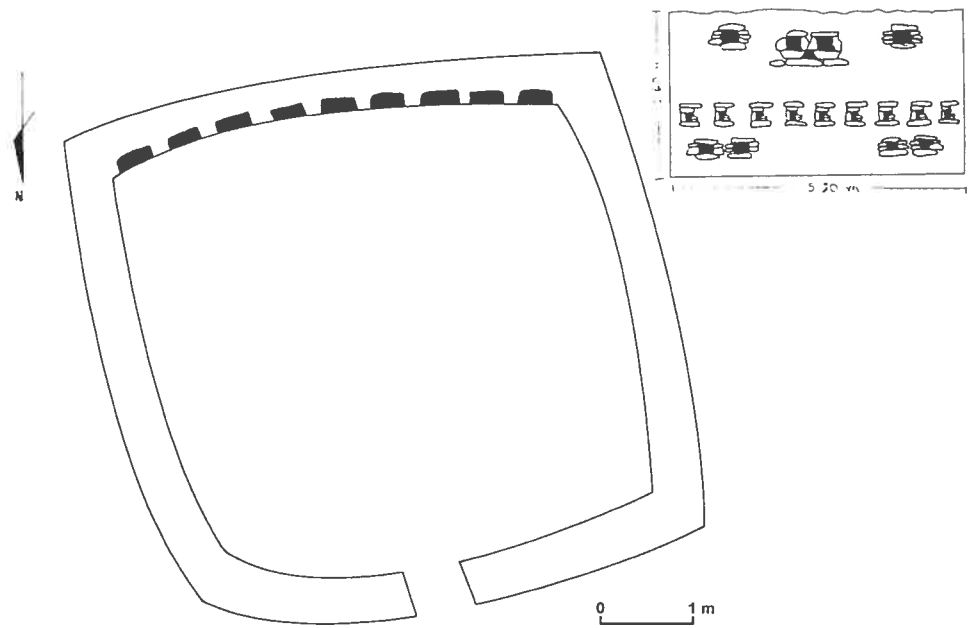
Plan et façade interne arrière d'une habitation du secteur II, site # 38 (Hijin II), Hijin.
